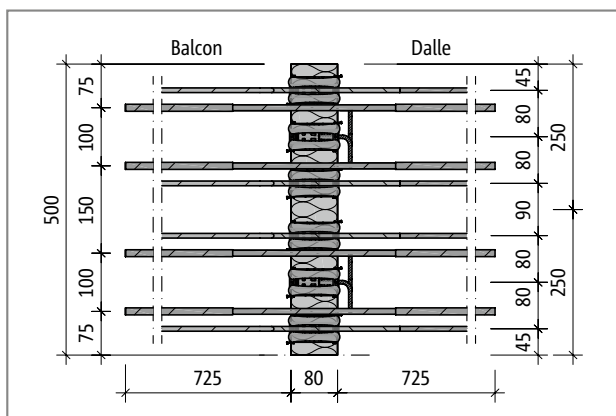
Schöck Isokorb® T Type K-E-M6 : Plan de base du produit de la variante L500
